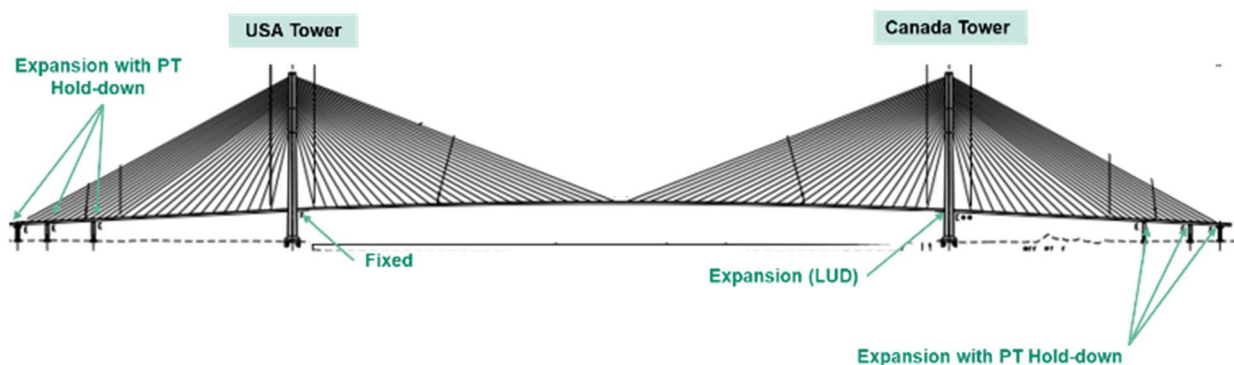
Alzado esquemático del puente, incluyendo configuración longitudinal
